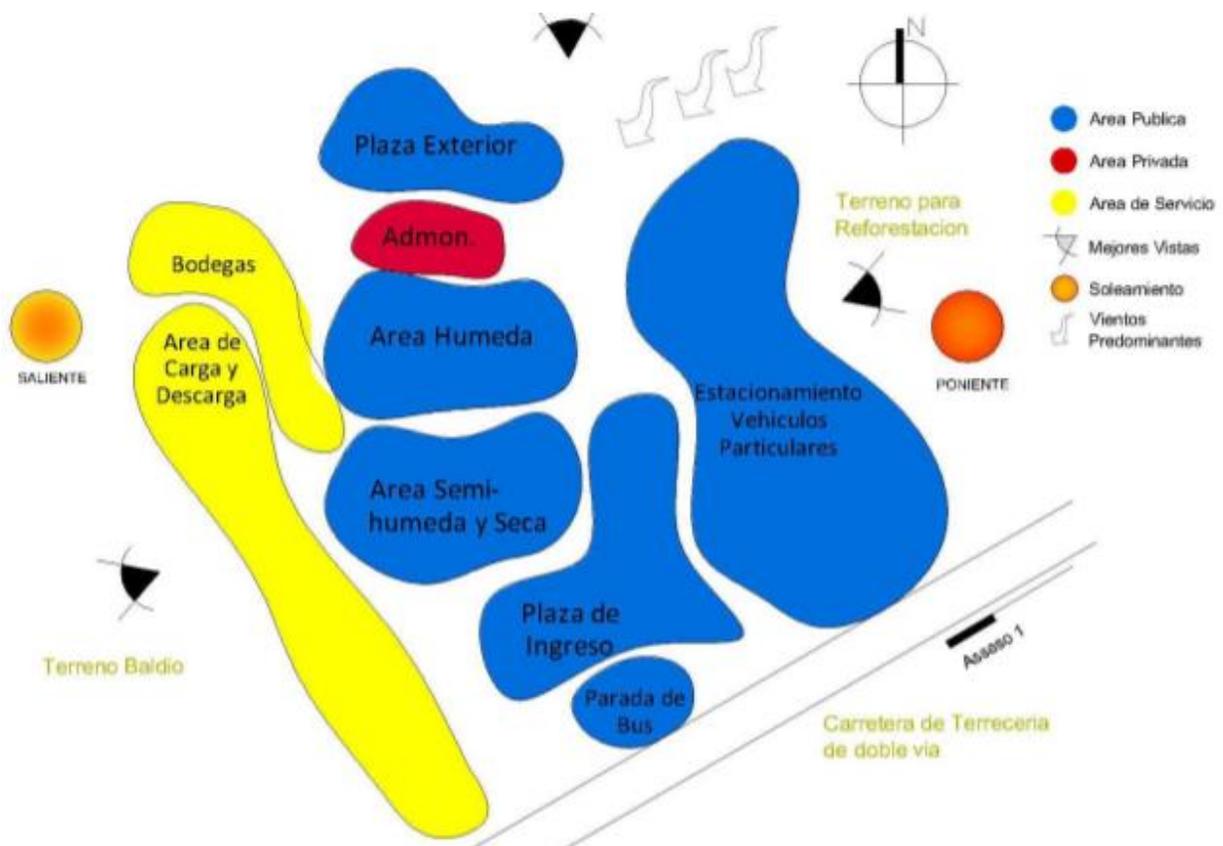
Terreno a intervenir la nueva propuesta de mercado
